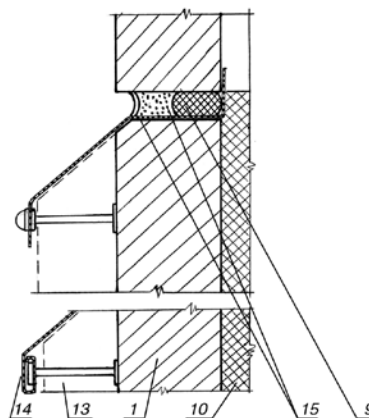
Фрагмент стыка между панелями 1-го этажа с наружным и внутренним несущими слоями и рядовой панелью наружной стены 2-го этажа с внутренним несущим слоем (см. рис. 8) при наличии навесного фасада по наружным поверхностям стеновых панелей 1-го и цокольного этажей: 1 – наружный несущий слой; 9 – гидроизоляционный участок; 10 – утепляющий вкладыш; 13 – навесной фасад; 14 – фартур; 15 – герметизирующая мастика
